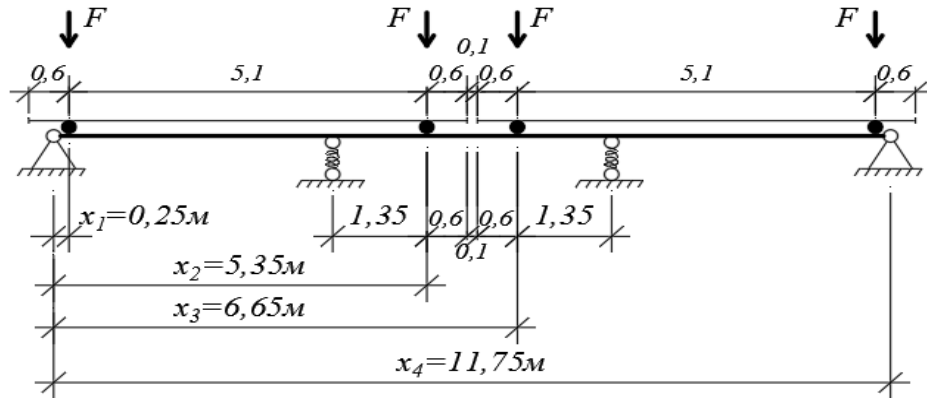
Нагрузки подкрановой балки с упруго- податливыми опорами по первому варианту
